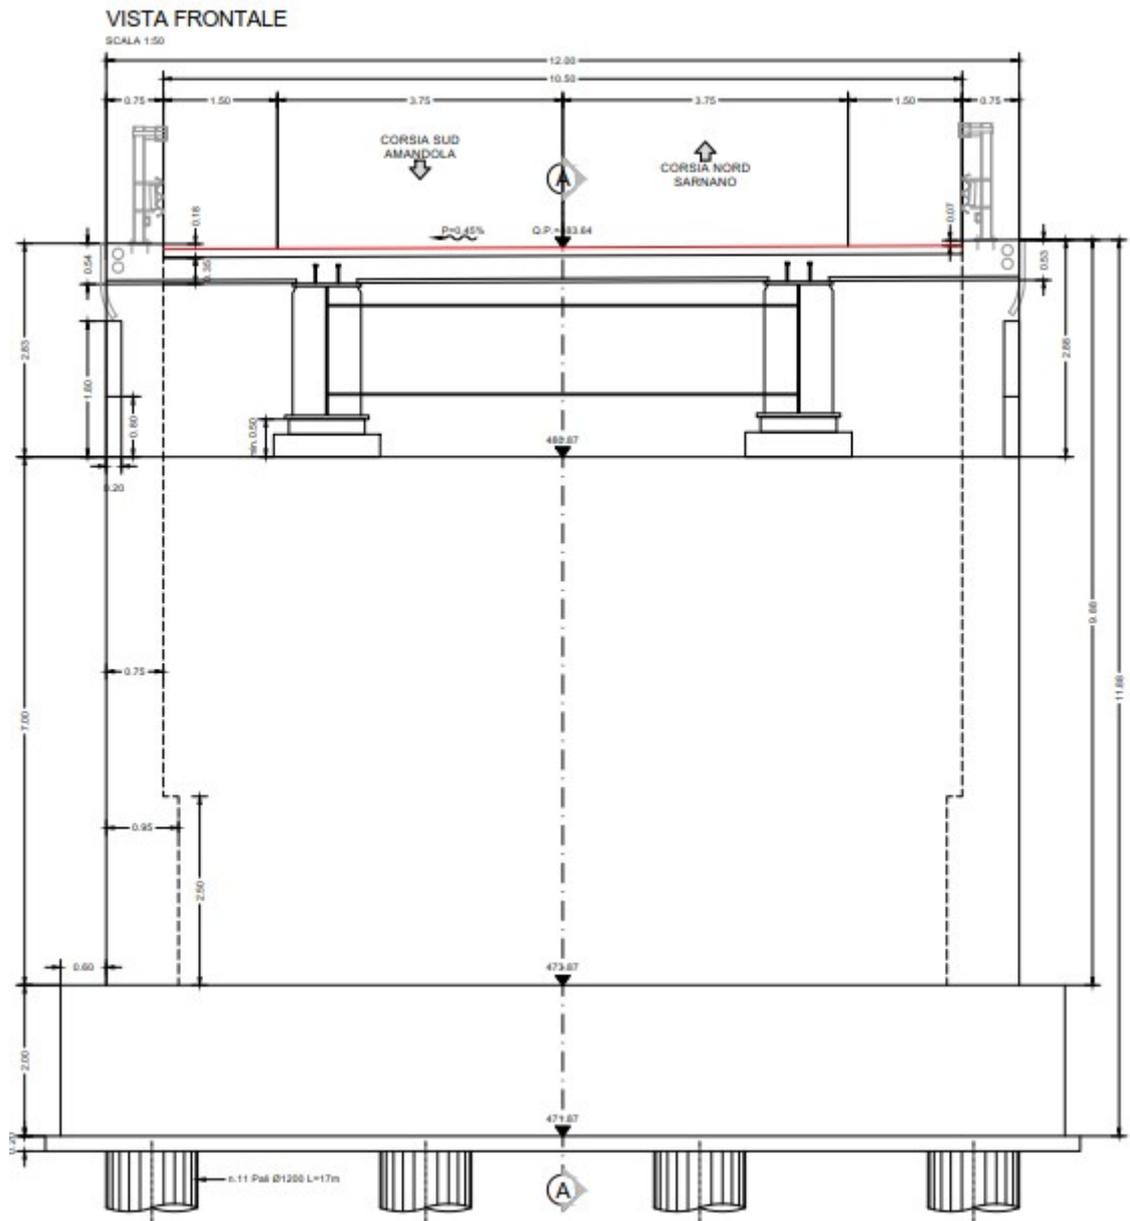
Vista frontale spalla A lato Sarnano
